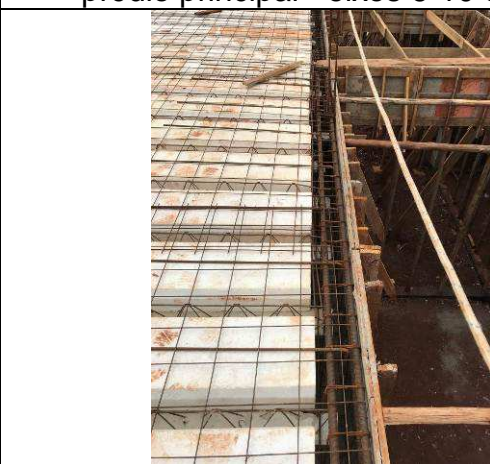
C: Lajes e vigas de cobertura do prédio principal - eixos 6-10 e G-I.
